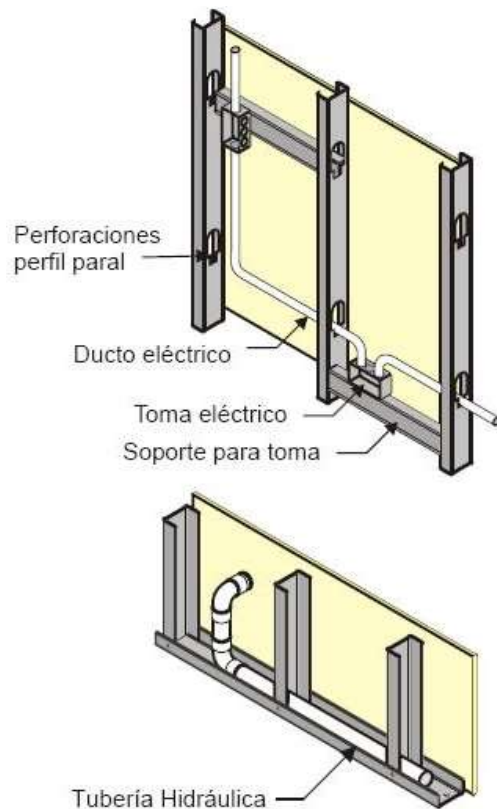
Detalle de tubería embutida en tabiquería de yeso o fibrocemento.
